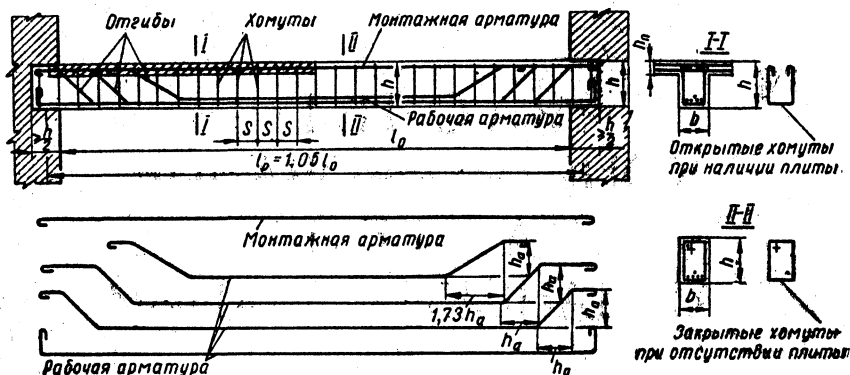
Армирование однопролетной балки отдельными стержнями.
